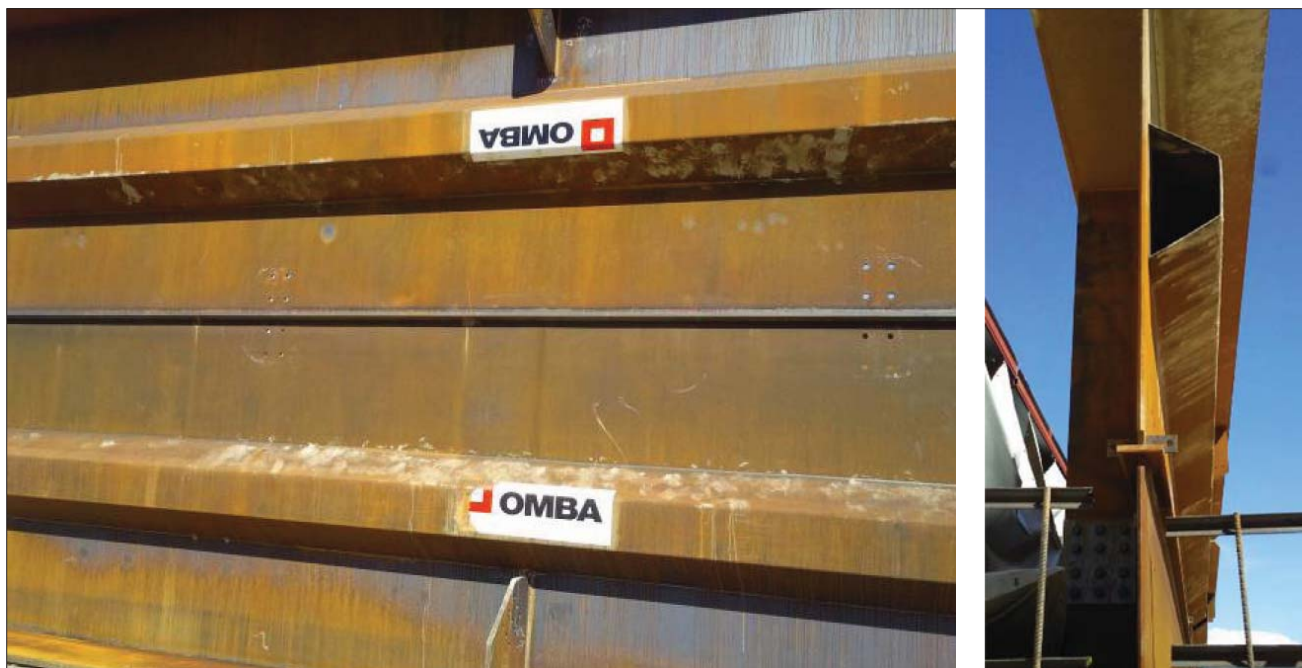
Collegamento longitudinale delle travi principali tramite saldatura a cordone d'angolo: prospetto a) e sezione b).
